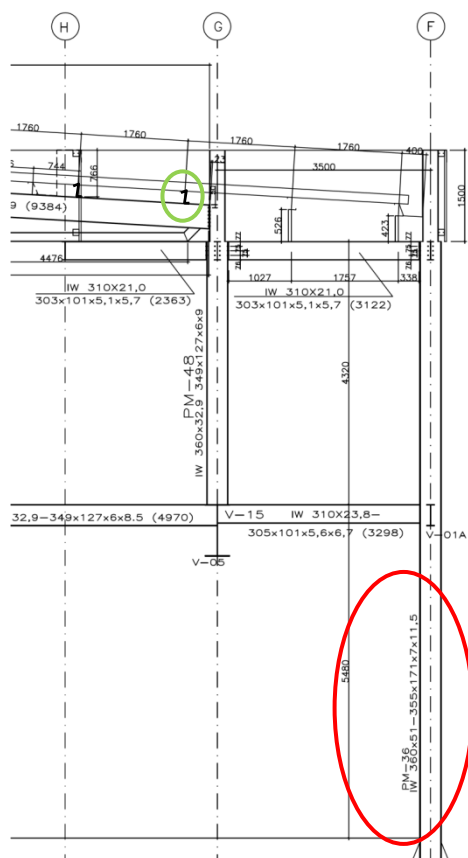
Detalhe pilar e terças – Projeto existente de estrutura de aço.
